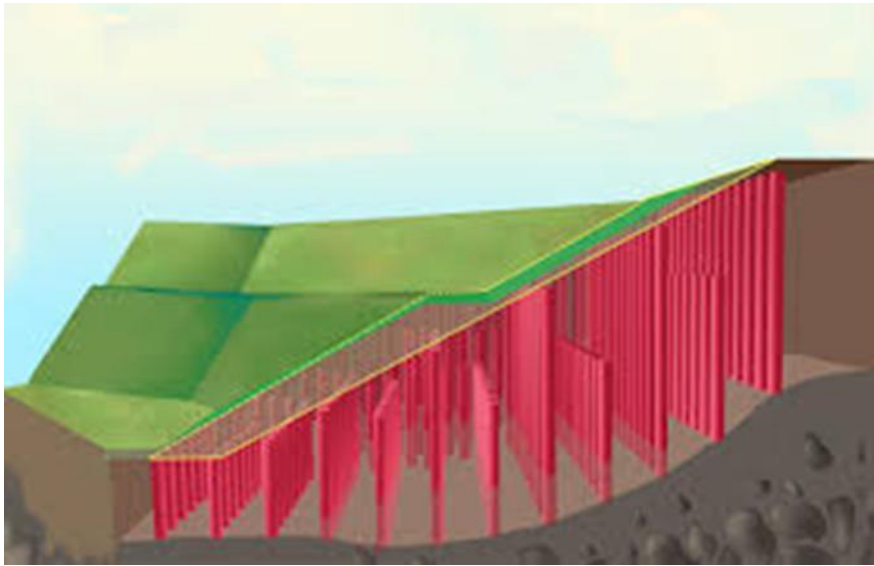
Estabilização de taludes com injeções e/ou colunas *jet-grouting
